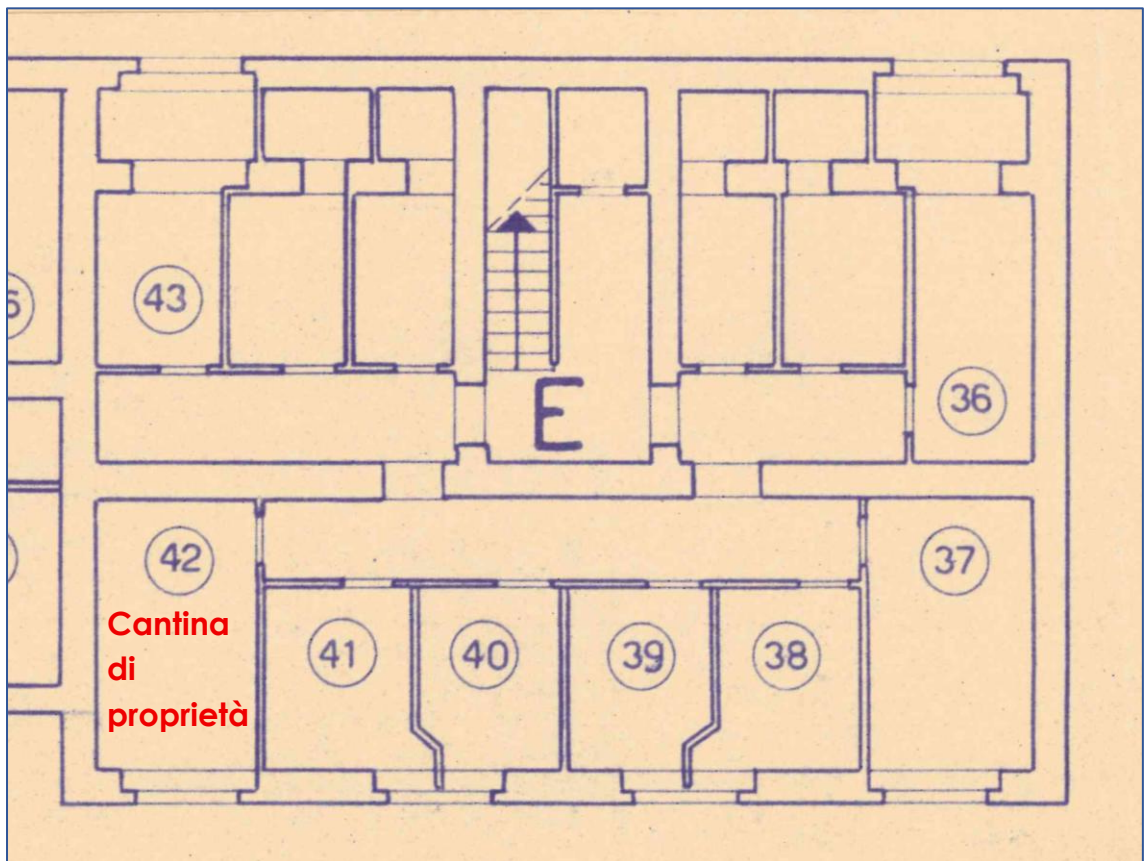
estratto planimetria piano cantina ricevuta ad Aler Milano
